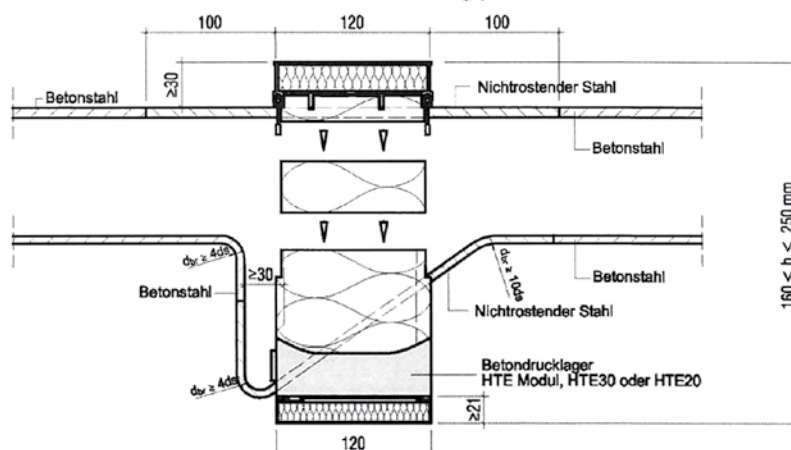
Schöck Isokorb Typ KF¹⁾ mit integrierter Aufhängebewehrung gem. Abschn. 3.3.1
